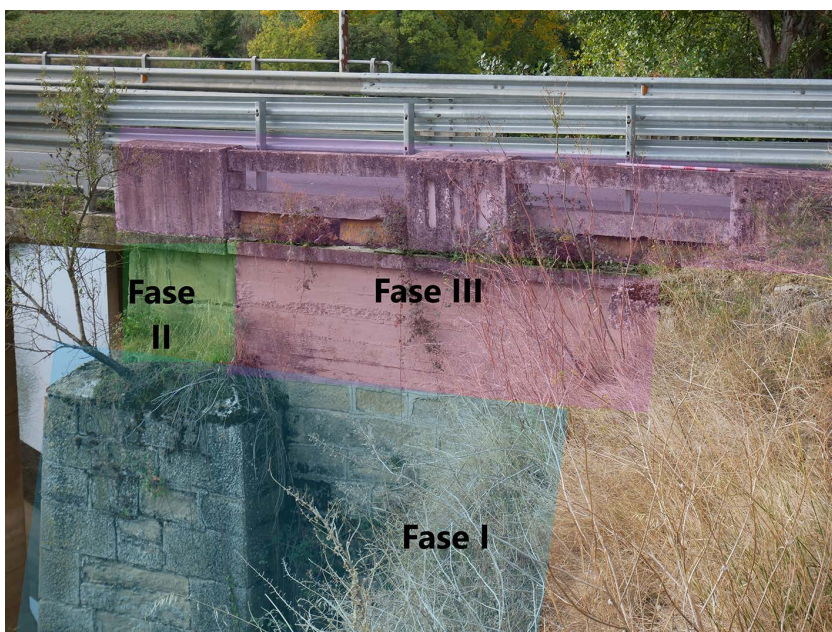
Las tres fases constructivas visibles en el puente de Lapuebla de Labarca
